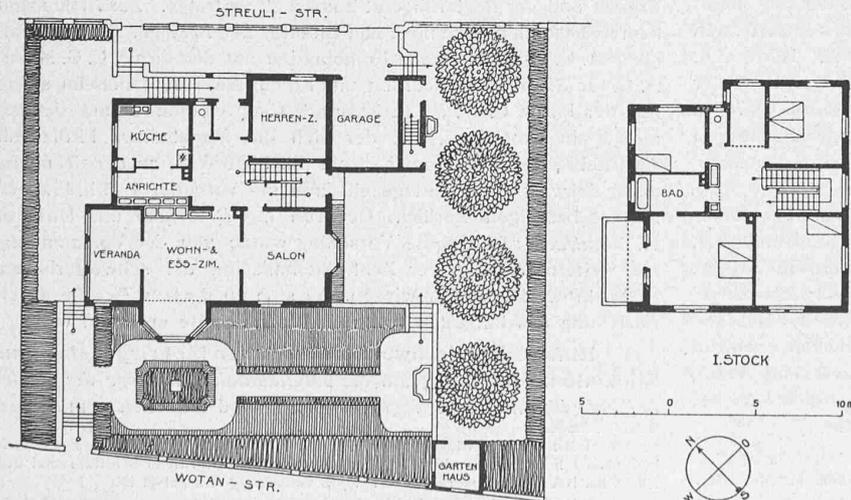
und 24. Einfamilienhaus Streulistrasse 54. — Grundrisse 1 : 400.
